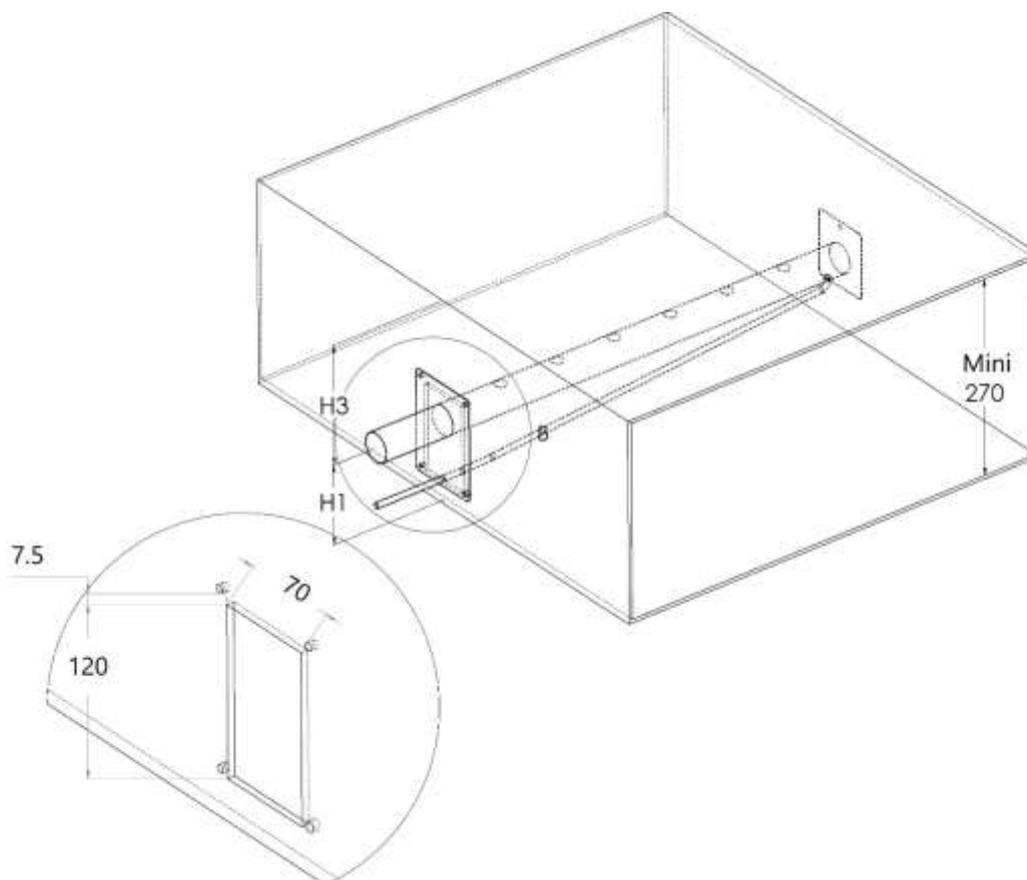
Dimensión del agujero a cortar en el conducto
